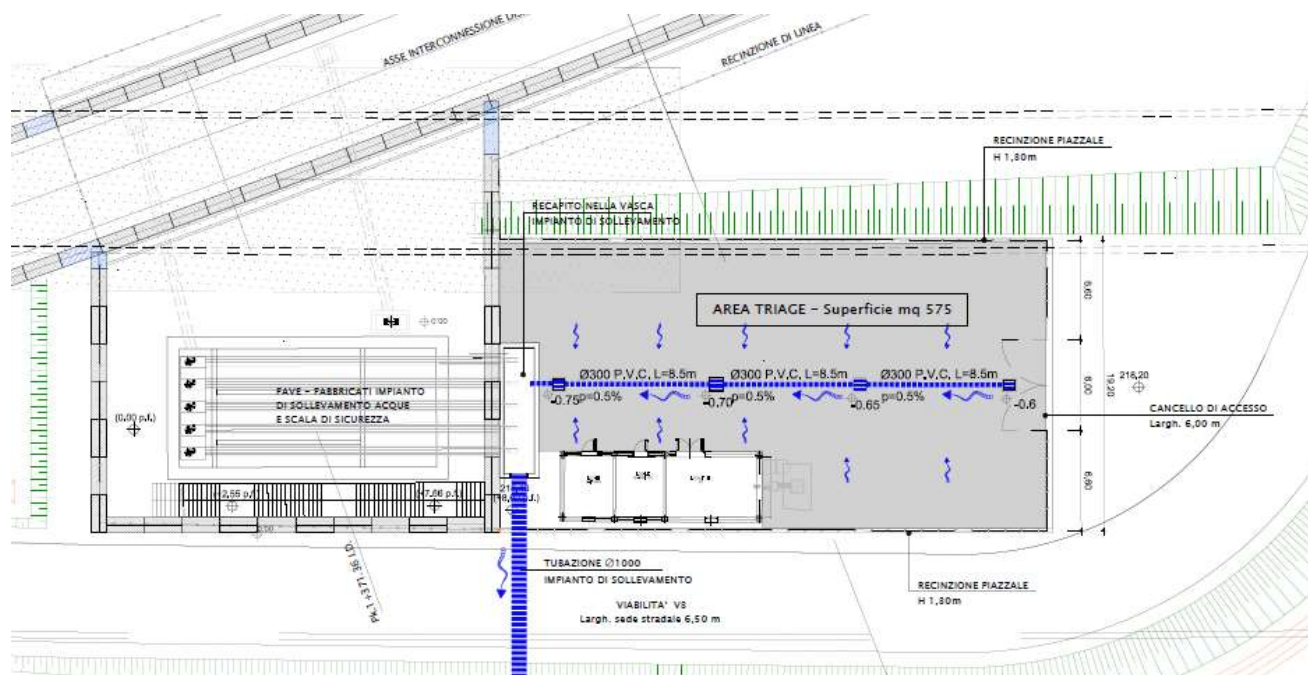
Progetto approvato – piazzale INVH - Pianta
